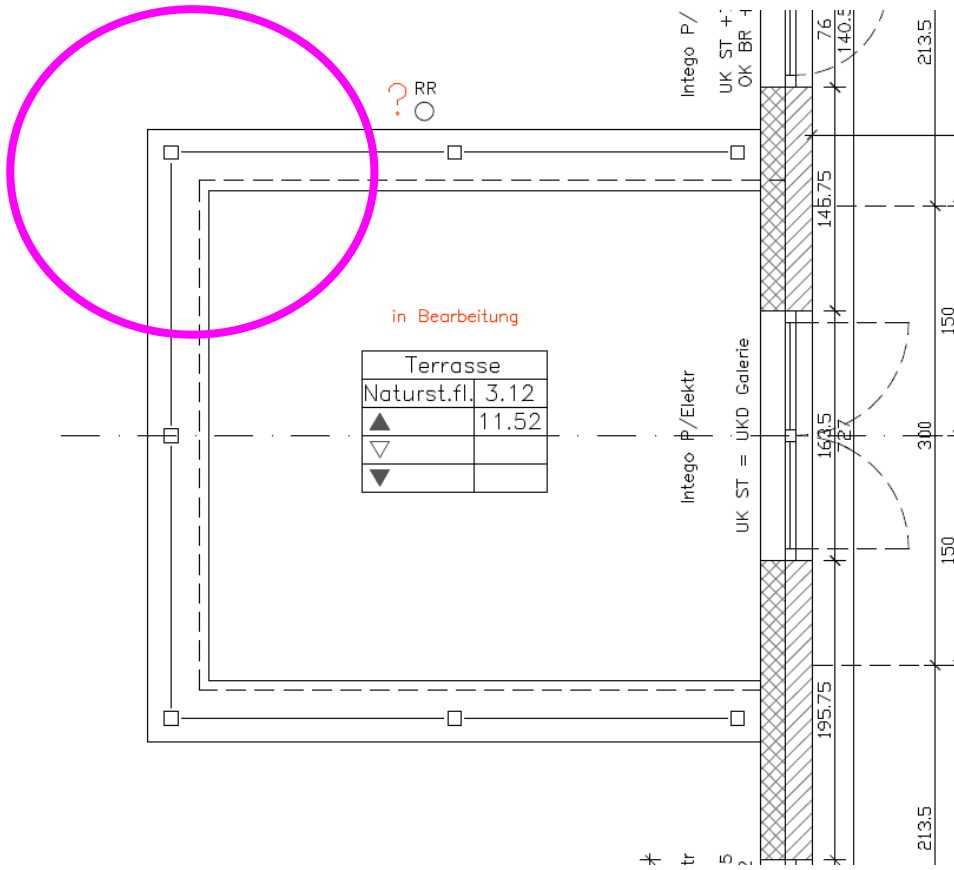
Ausschnitt aus Werkplan, Grundriss DG
